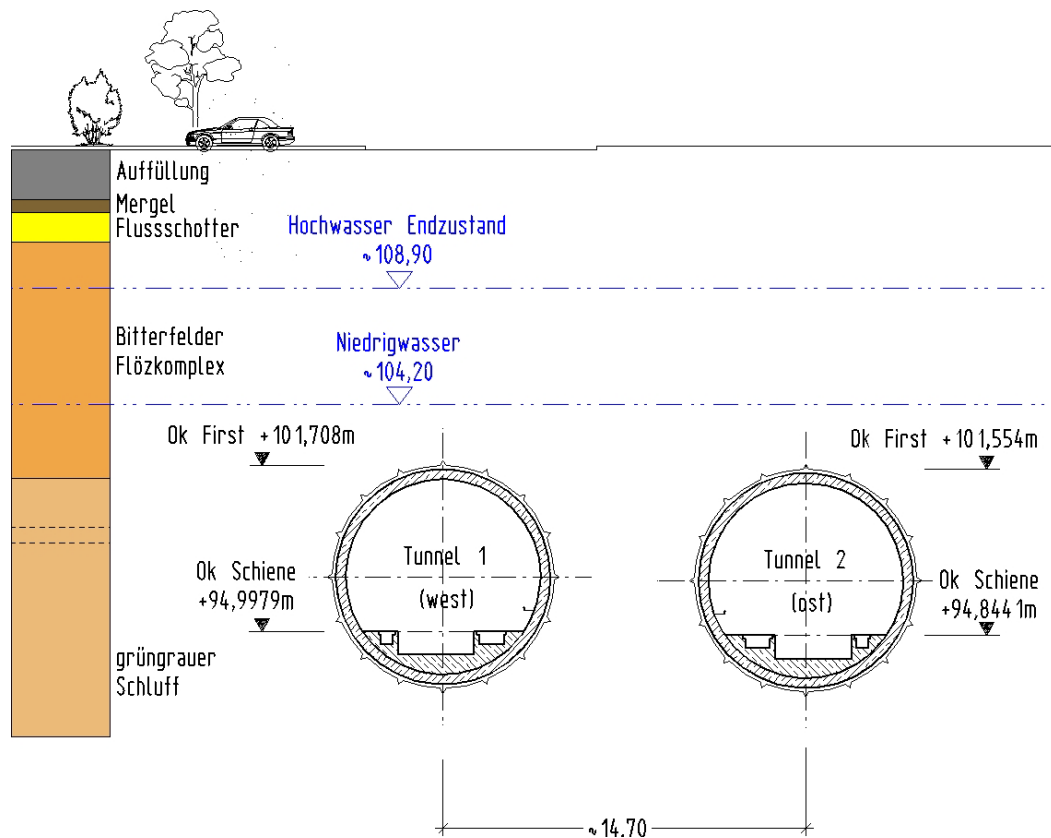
Berechnungsschnitt Alte Markthallen ohne vorhandene Bebauung
